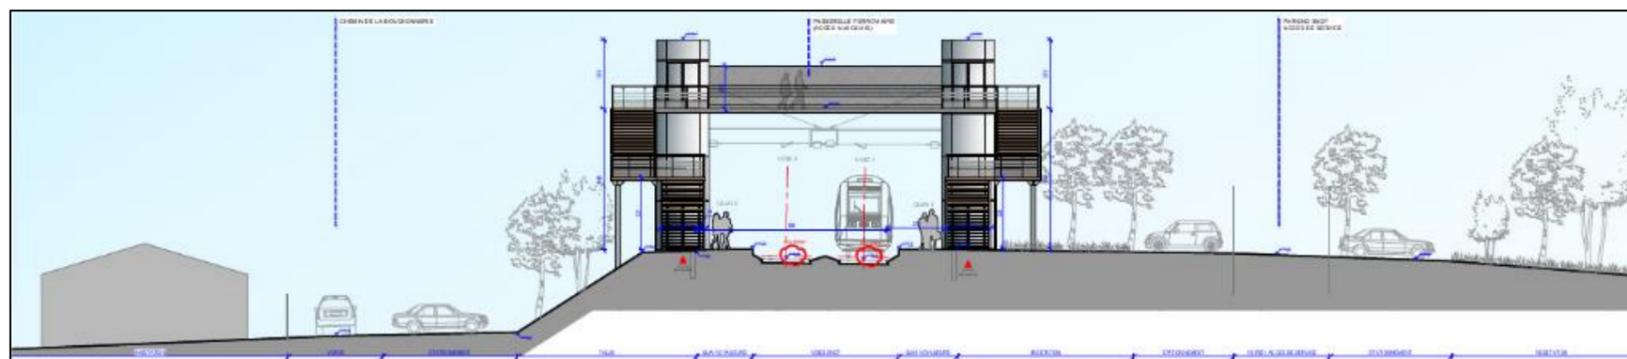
Puget-Ville - coupe de principe sur la passerelle (AREP, 2021)
